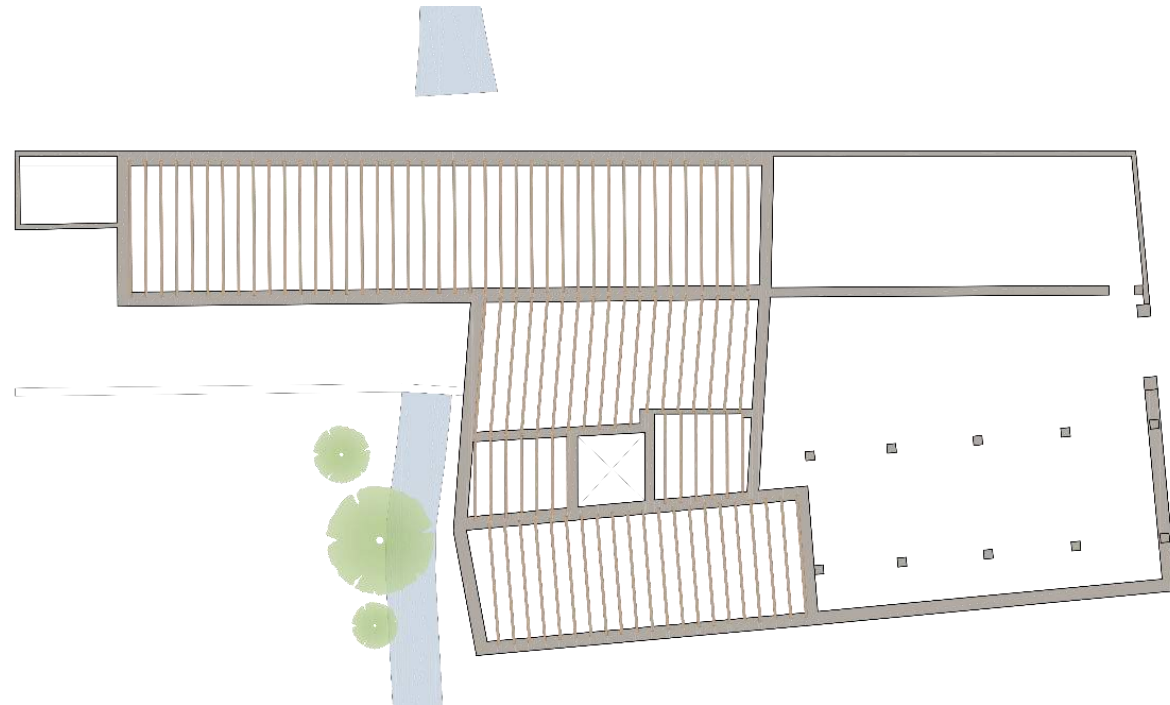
Esquema estructural forjado revoltón. Autor Propio. 2015
